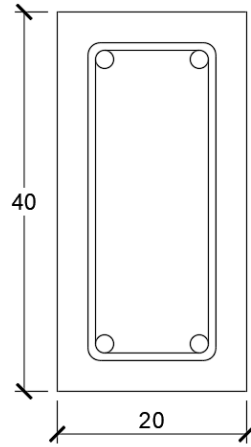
Detalle del armado de vigas para el modelo 1, cotas en centímetros
